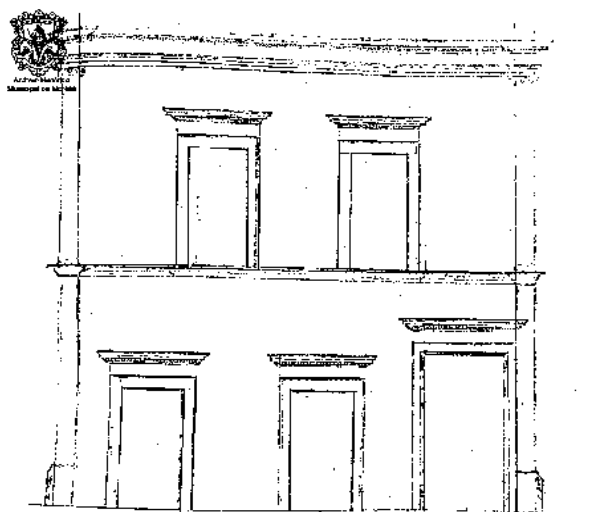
Se observa la fachada de la casa que Ignacio Ladrón de Guevara presenta ante Ayuntamiento para su aprobación.
